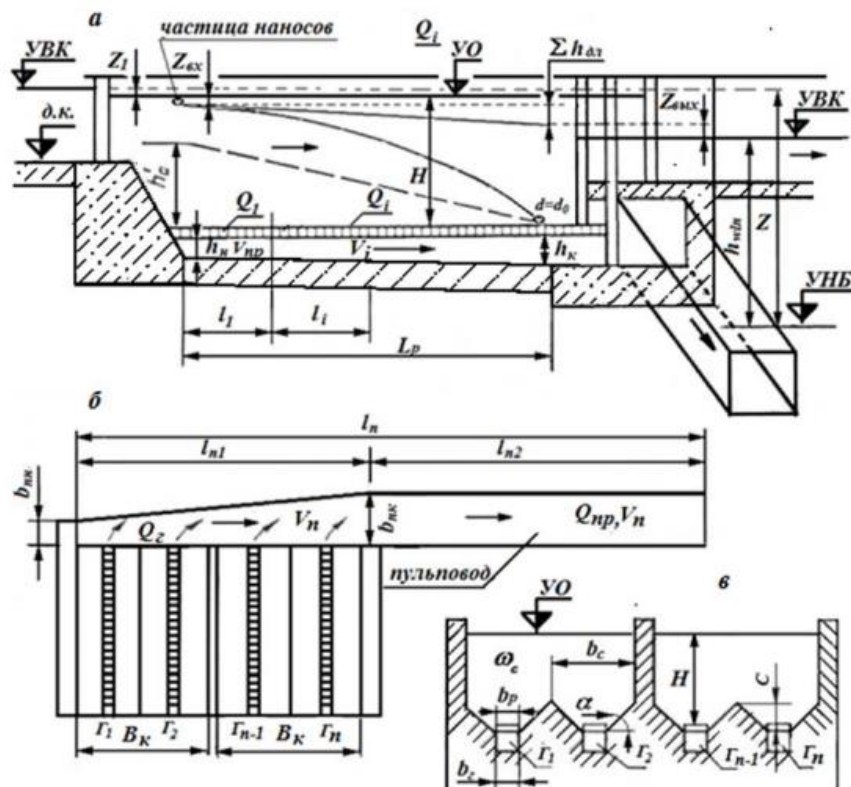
Схемы к расчету отстойника с непрерывным промывом наносов: а – сборно-промывной галереей; б – пульповода; в – основных размеров камеры: 1 – входной оголовок; 2 – выходной оголовок; 3 – сборно-промывная галерея; 4 – ребро; 5 – решетка; 6 – пульповод
